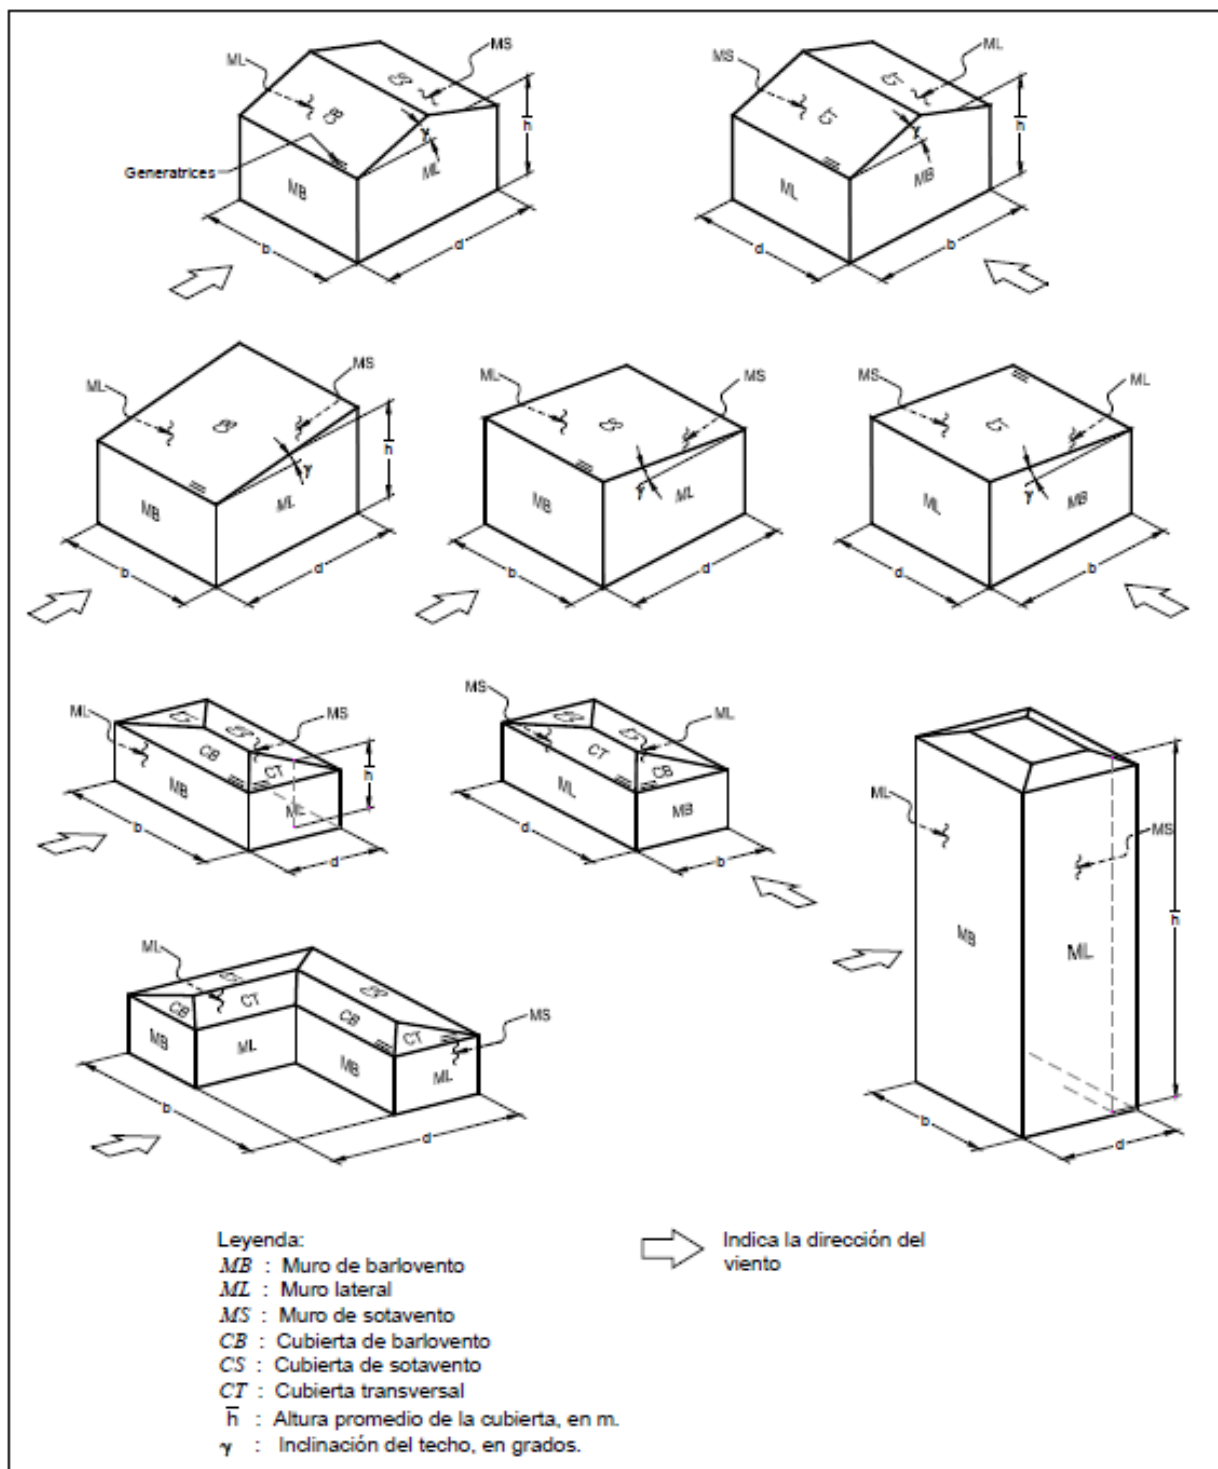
Definición de parámetros de construcción con planta cerrada.
